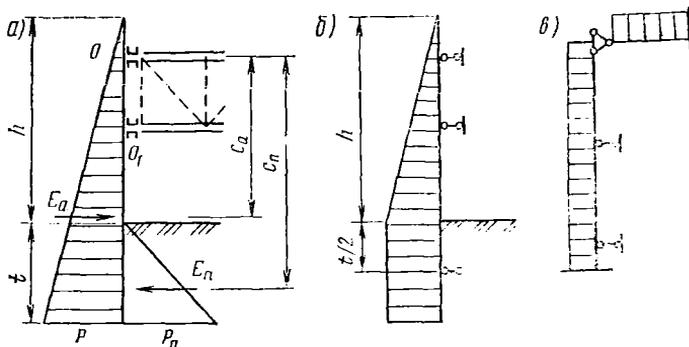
Расчетные схемы шпунтовых ограждений
